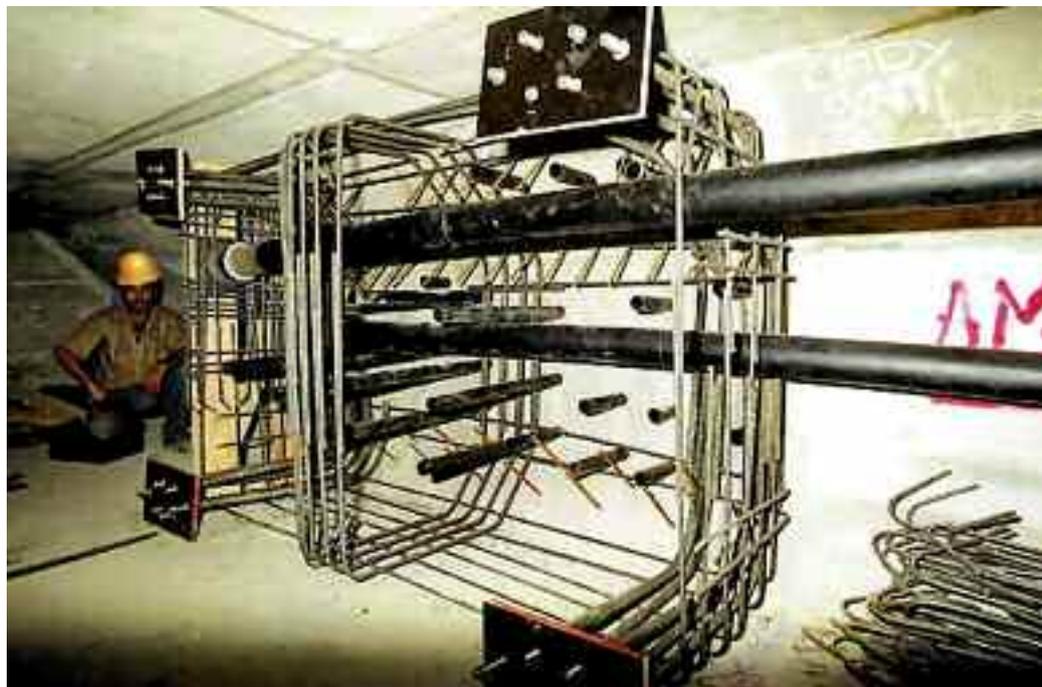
mise en place du ferrailage, des câbles de la précontrainte additionnelle longitudinale et des platines des tirants-butons (crédit photo Sêtra)
